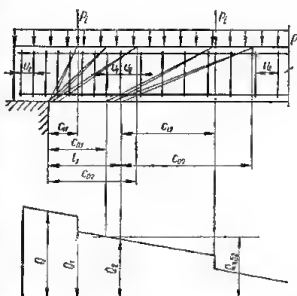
Наиболее опасные наклонные сечения в изгибаемом железобетонном элементе с меняющимся по длине поперечным армированием.
